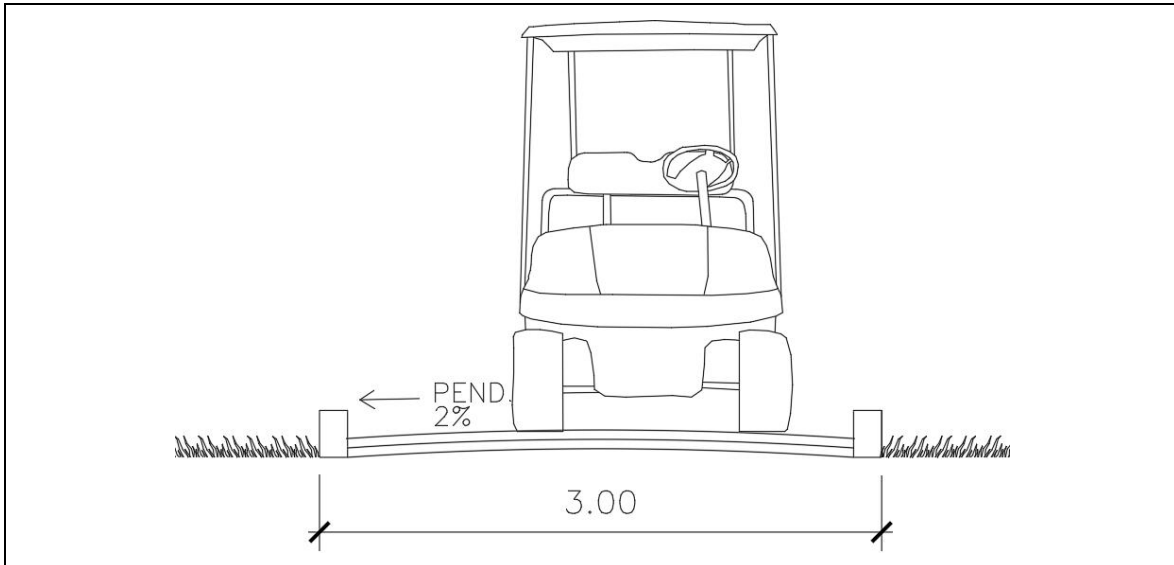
Sección vial en vialidades tranquilizadas tipo "A"
